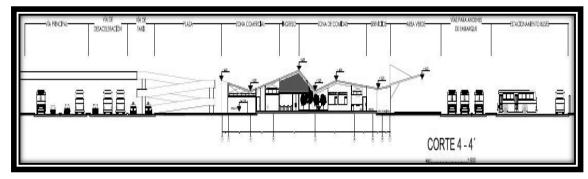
Planos del terminal Tipo 3 para el cantón Archidona (Vista Lateral 4) Fuente: (Túqueres, 2017).
